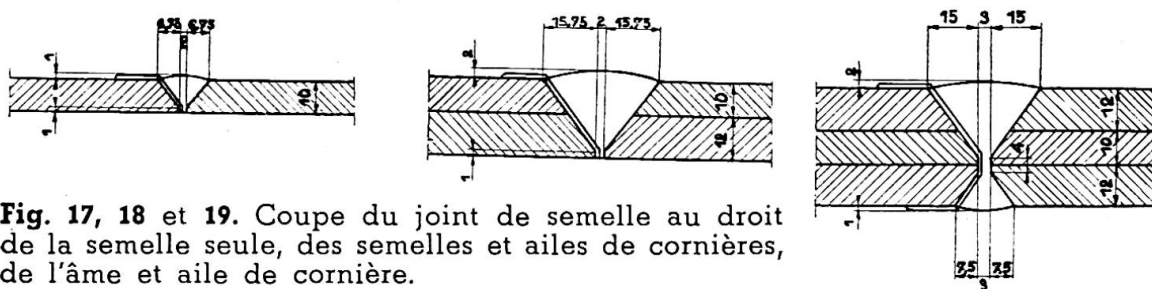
, 18 et 19. Coupe du joint de semelle au droit de la semelle seule, des semelles et ailes de cornières, de l'âme et aile de cornière.
